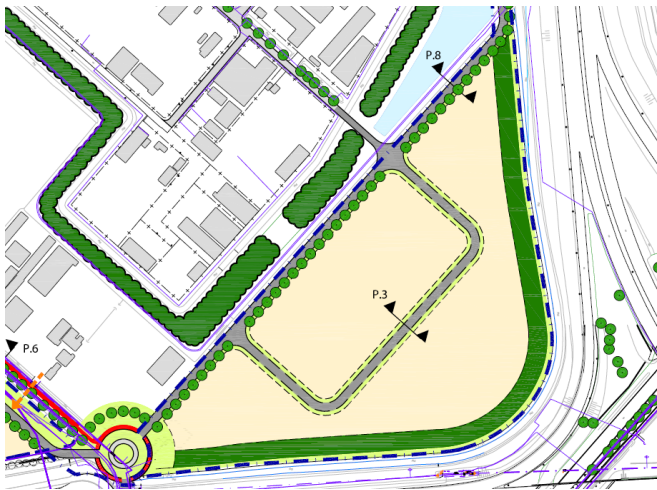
Stedenbouwkundig plan De Liede West, Studio Scale 2010.
